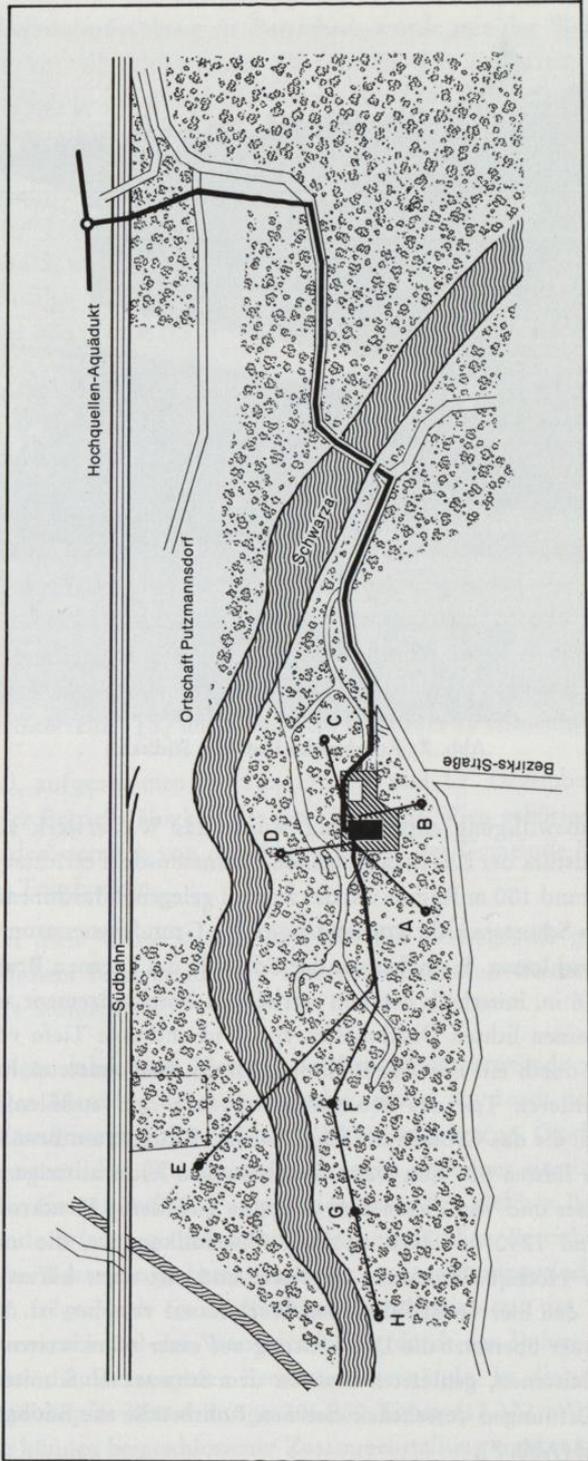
Lageplan des Schöpfwerkes Pörschach um 1900
